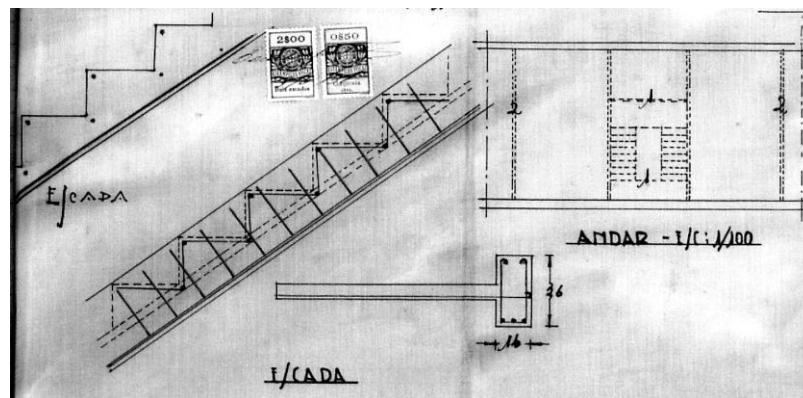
Pormenor construtivo das escadas e bloco central [6]
